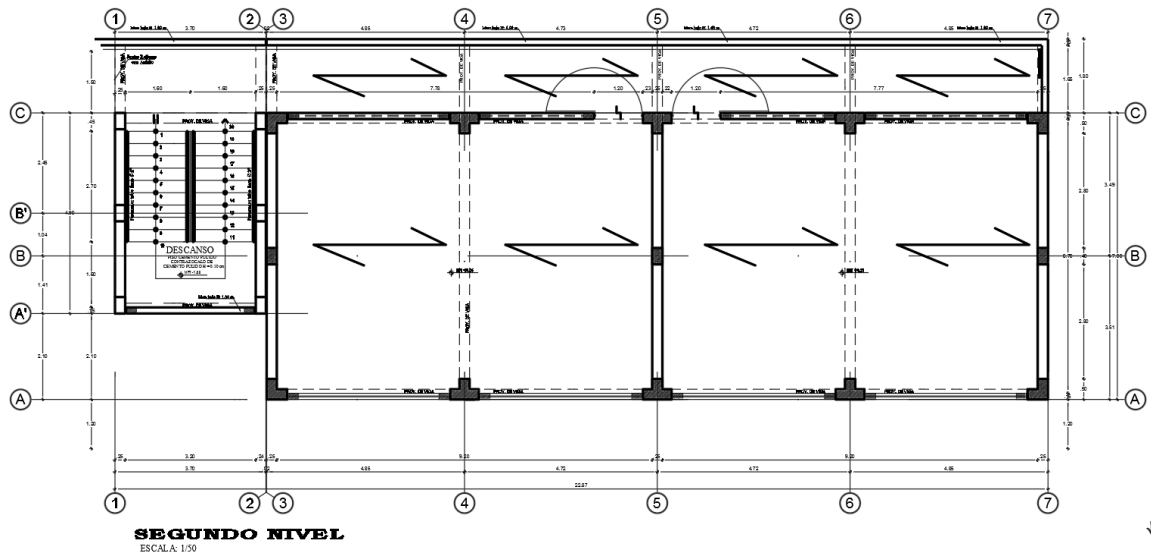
Planta del Modulo Propuesto Segundo Piso
